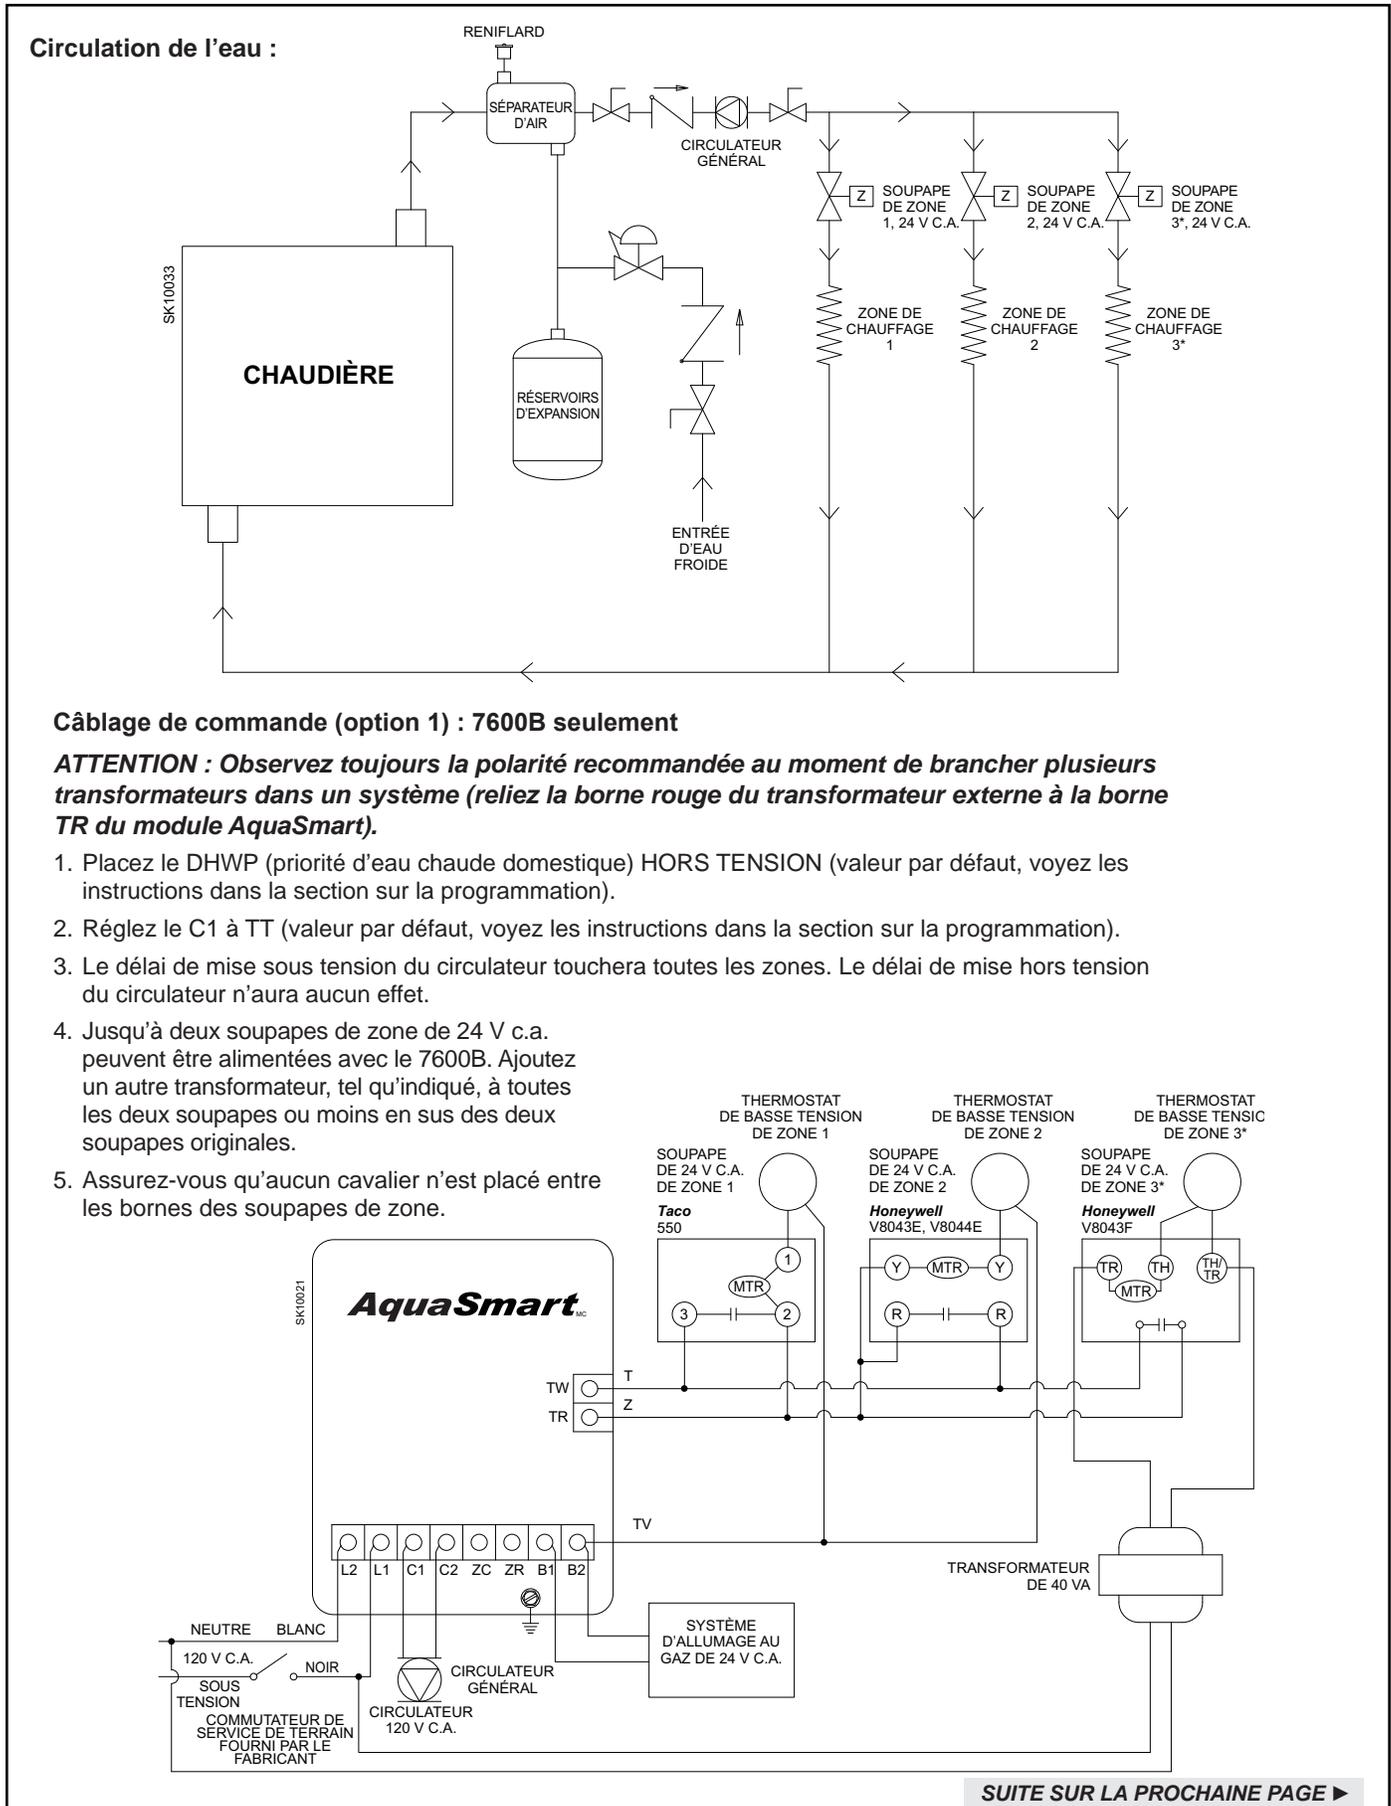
(suite) – Branchements alternatif de zones multiples du 7600A/B avec ou sans chauffe-eau sans réservoir
